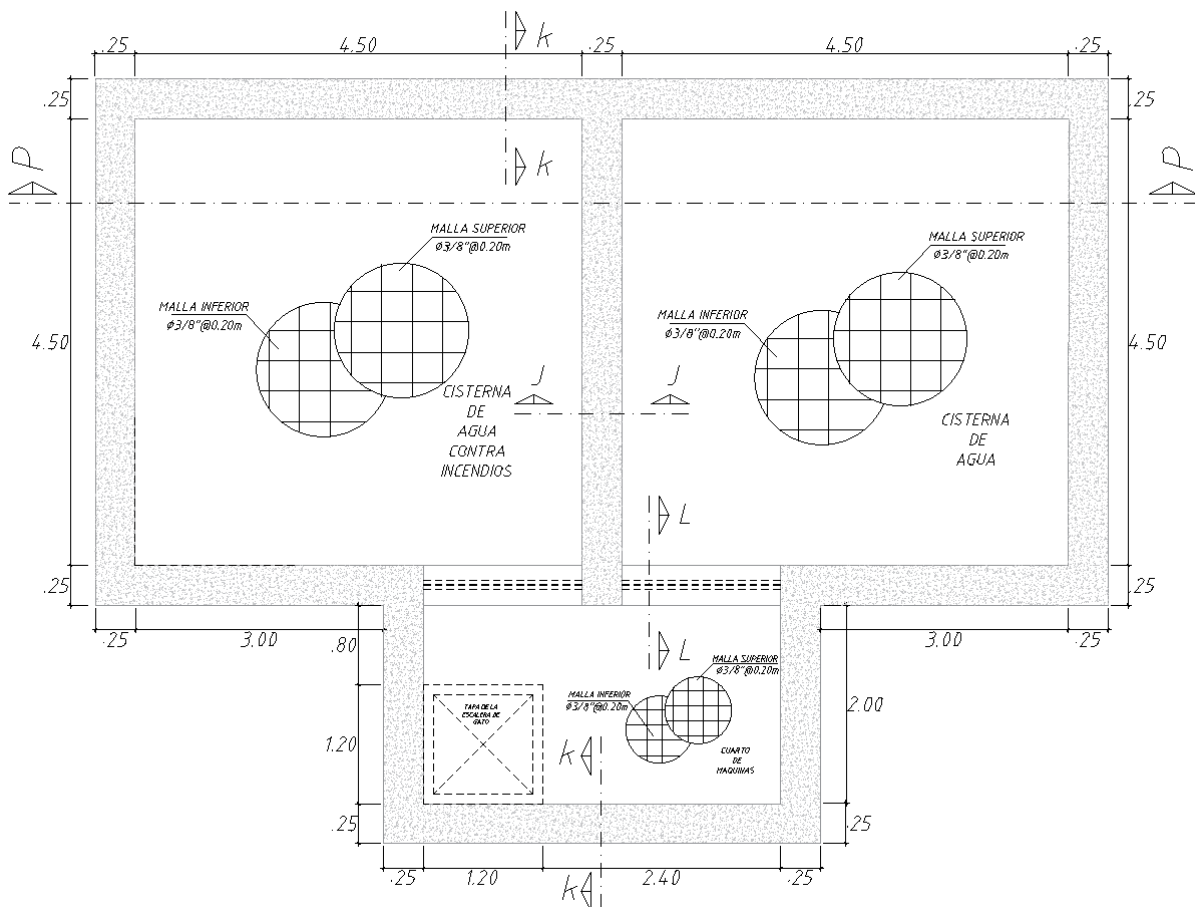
Planta de la cisterna con el armado de refuerzo final.
